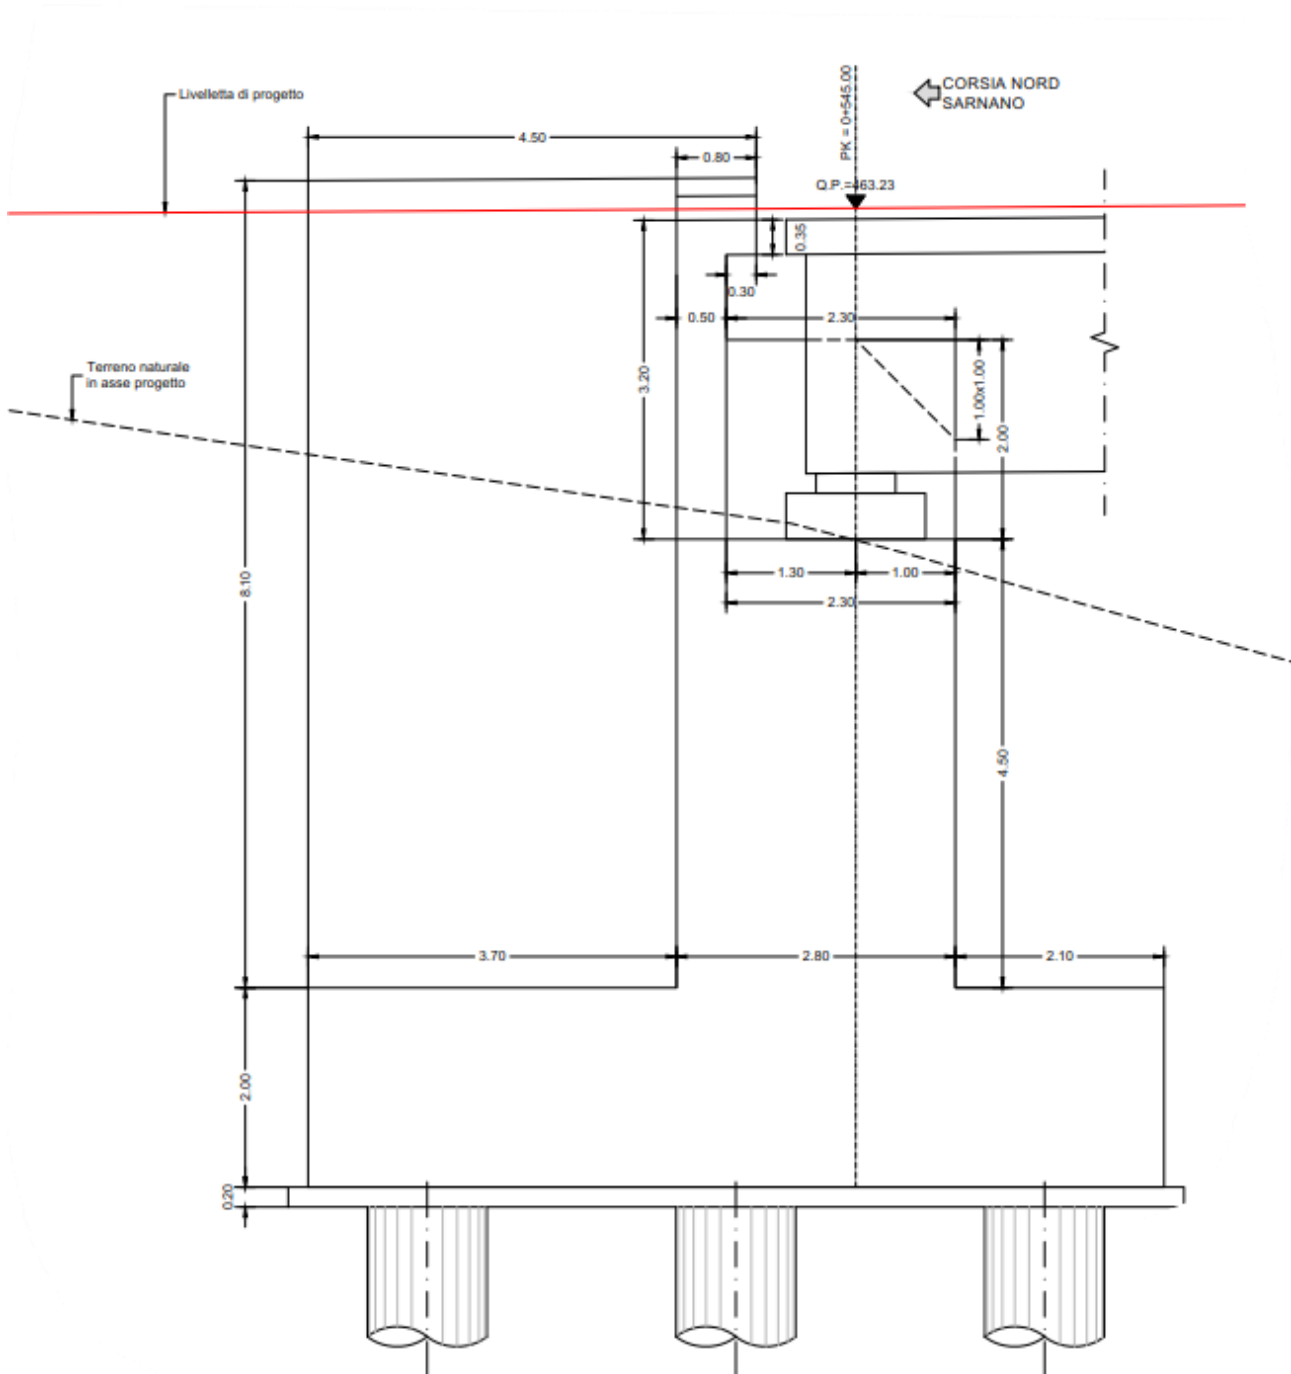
Sezione trasversale spalla A lato Sarnano
